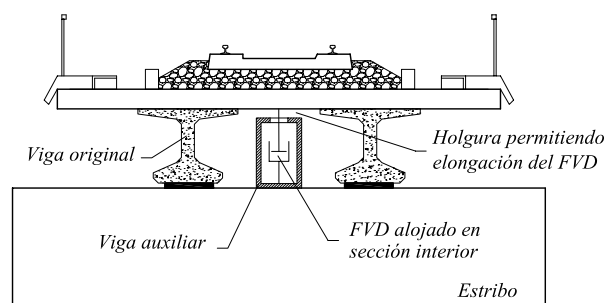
Configuración del sistema de vigas auxiliares en un puente de vigas y losa de reparto de vía única
